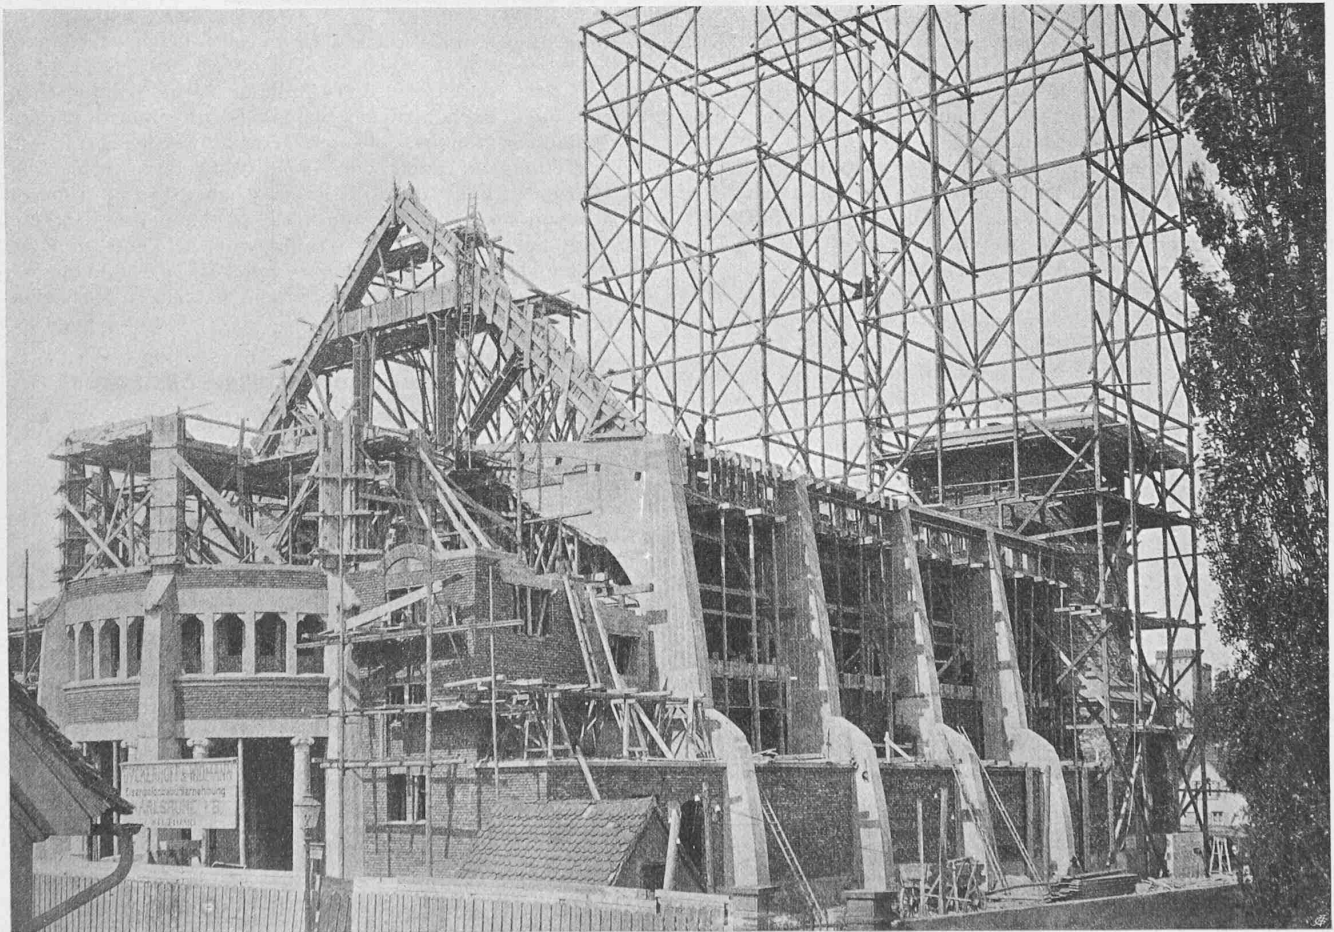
Ansicht des Orgelvorbaues und des Fachwerk-Dachbinders während der Ausführung.
